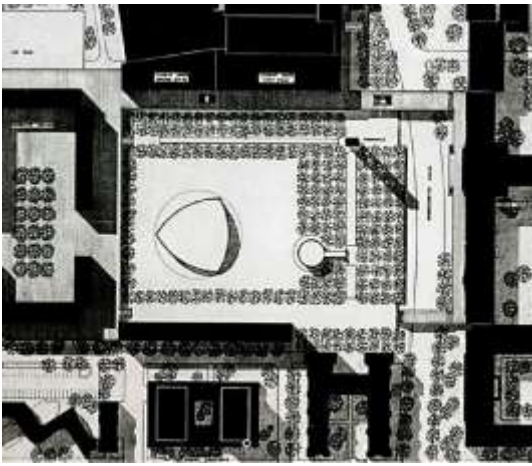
Disegni – Planivolumetrico e planimetria della Kresge chapel
